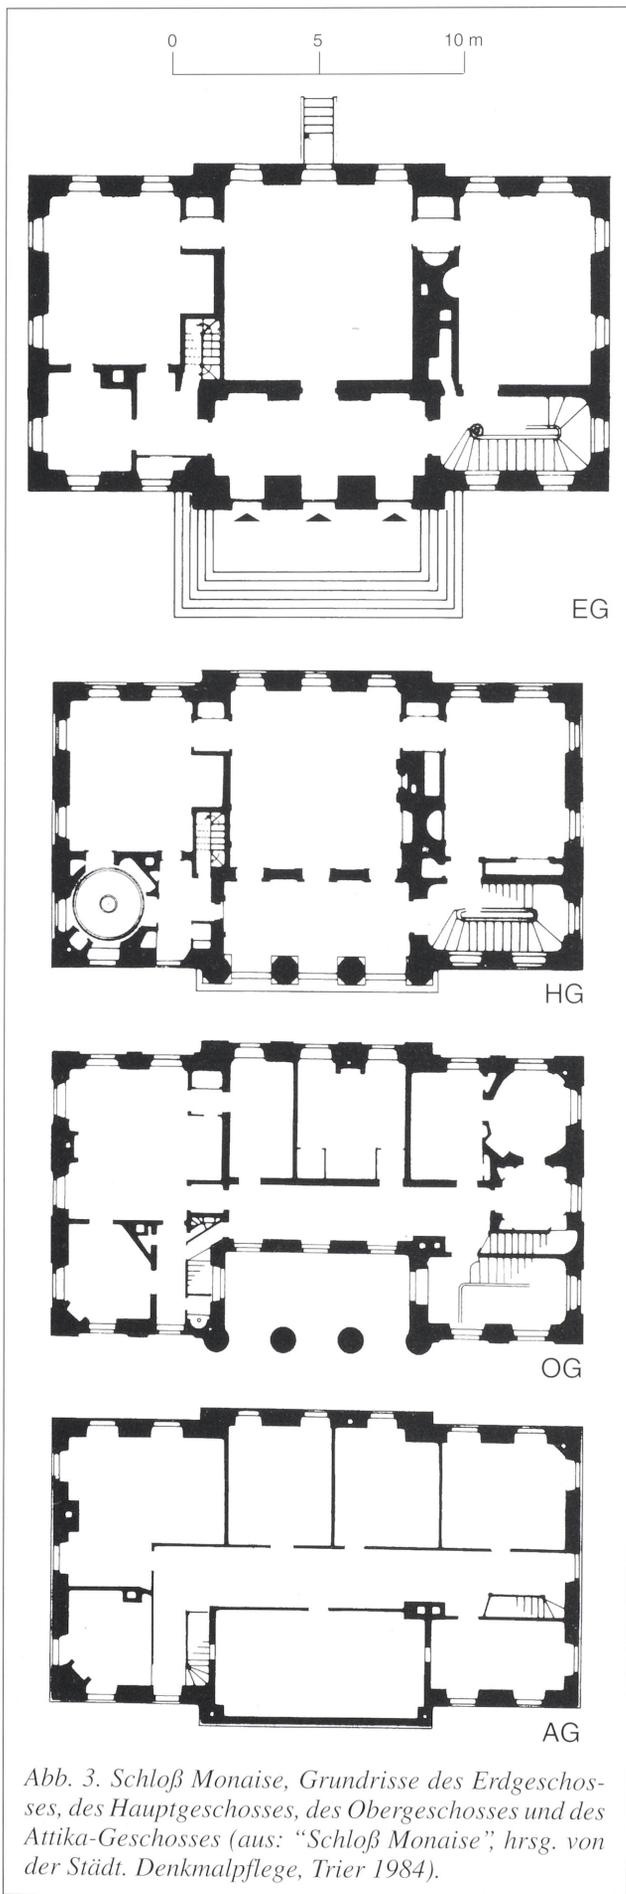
Schloß Monaise, Grundrisse des Erdgeschosses, des Hauptgeschosses, des Obergeschosses und des Attika-Geschosses (aus: "Schloß Monaise", hrsg. von der Stadt. Denkmalpflege, Trier 1984).
